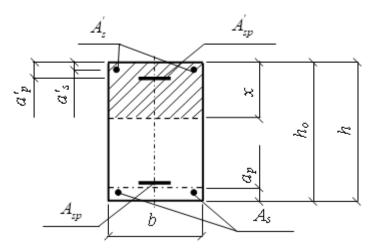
Поперечное прямоугольное сечение изгибаемого железобетонного элемента
